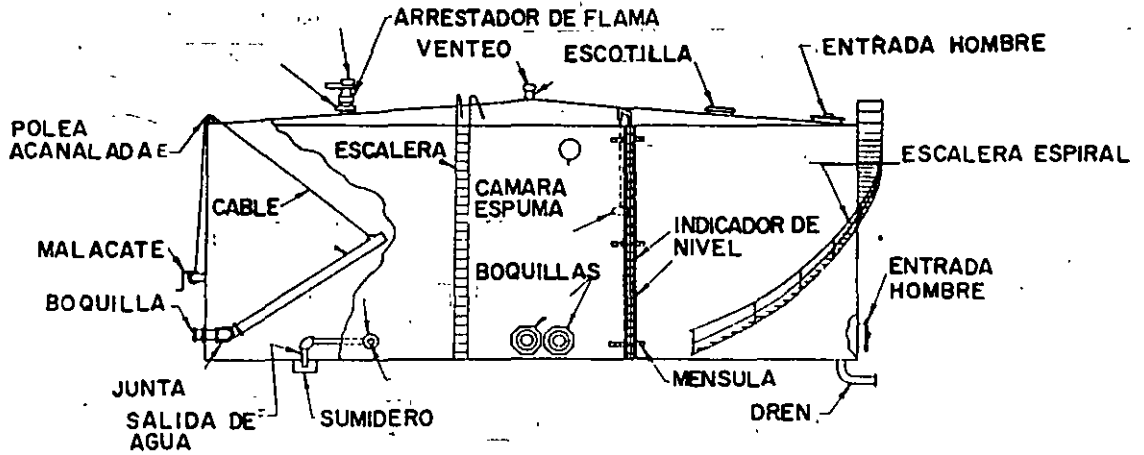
ARREGLO TIPICO DE ACCESORIOS PARA UN TANQUE DE TECHO FIJO
